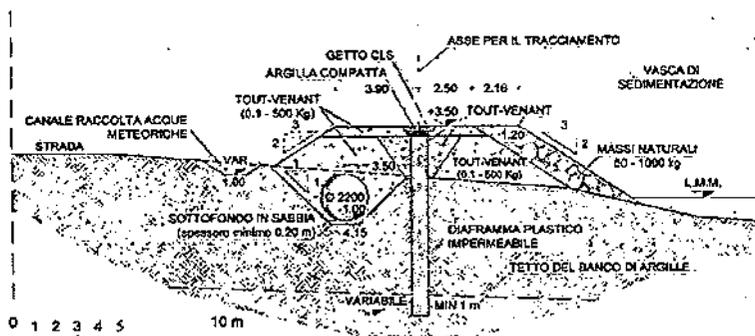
Sezione tipo G2-G2 (argine di delimitazione lato terra con protezione sul lato interno)
